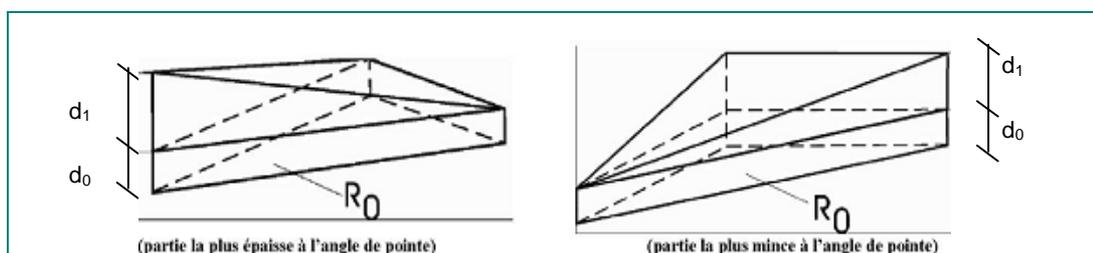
Éléments de construction avec base triangulaire, composés d'une partie inclinée et d'une partie plane (restante)
